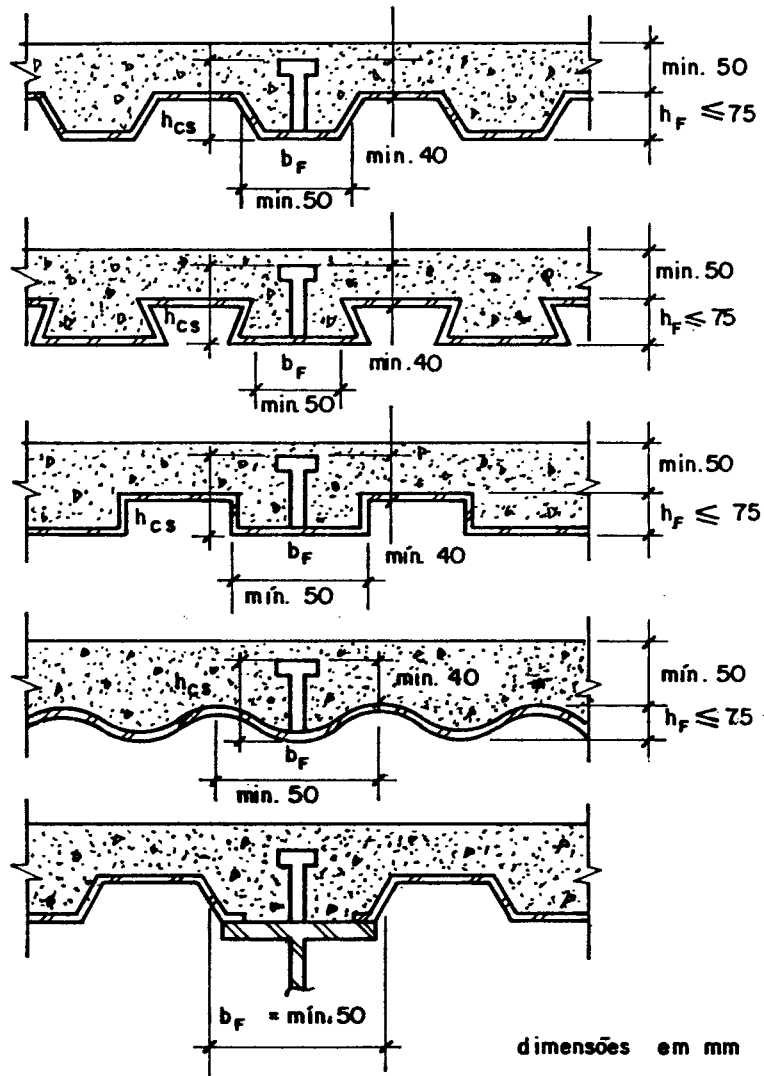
LAJES DE CONCRETO COM FORMA DE AÇO INCORPORADA
